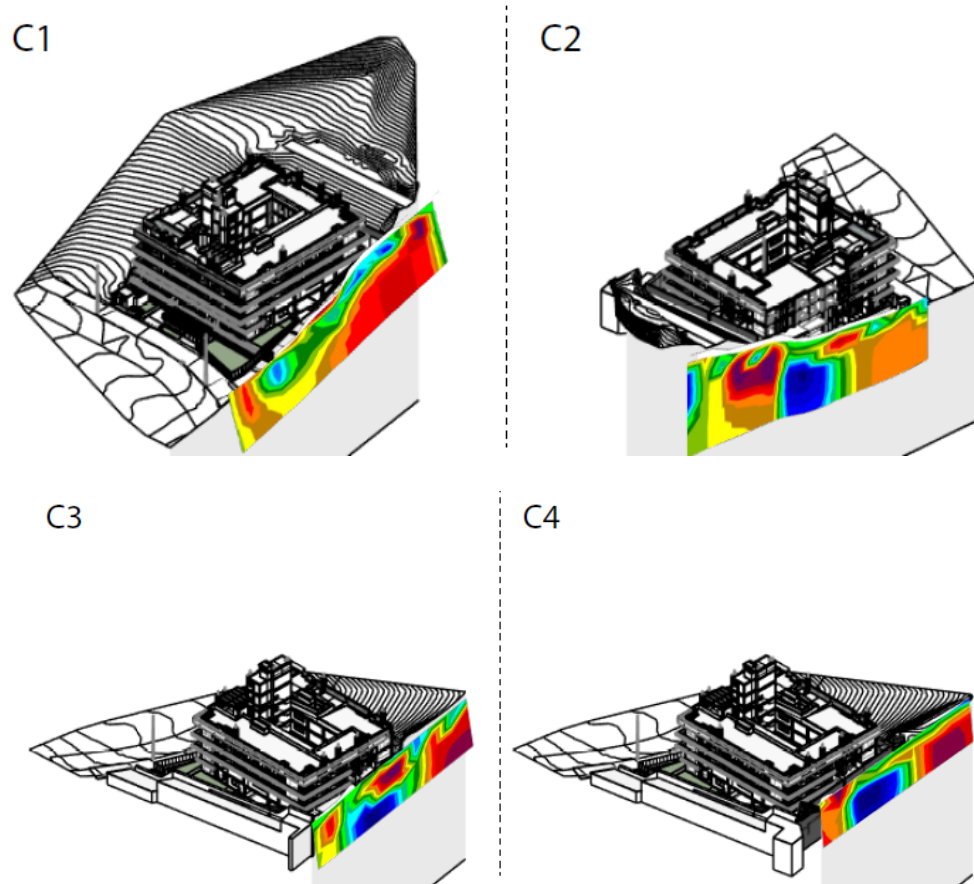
Planta de localização dos caminhamentos desenvolvidos
